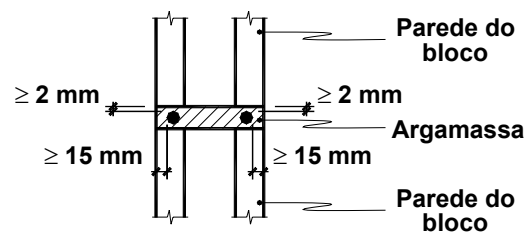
Cobrimento das armaduras em juntas de assentamento
